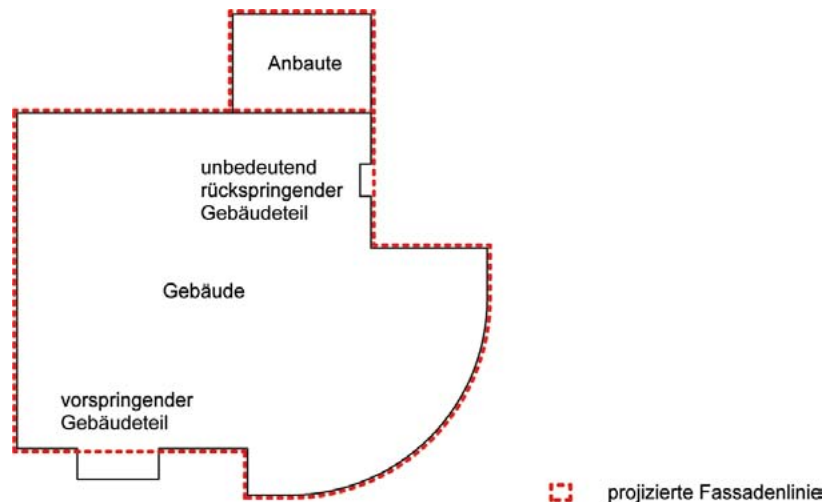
Gebäude, Anbauten und Kleinbauten
